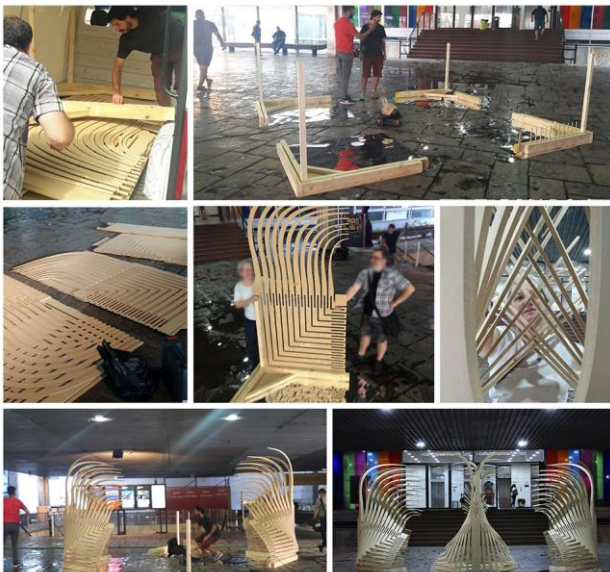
Traslado y armado de ALADA. Fuente: Autores.
